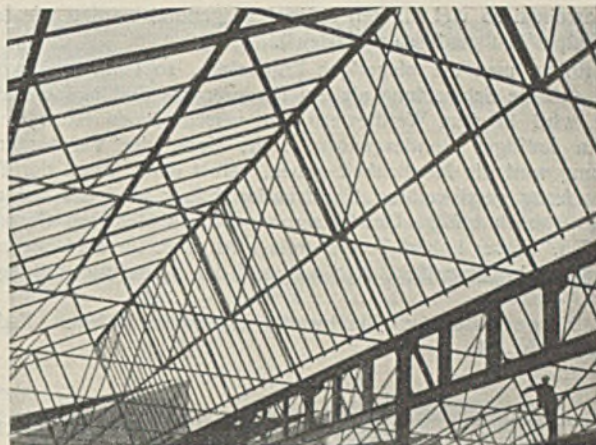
Geschweißte Vierendeelträger und geschweißtes Sägendach.
